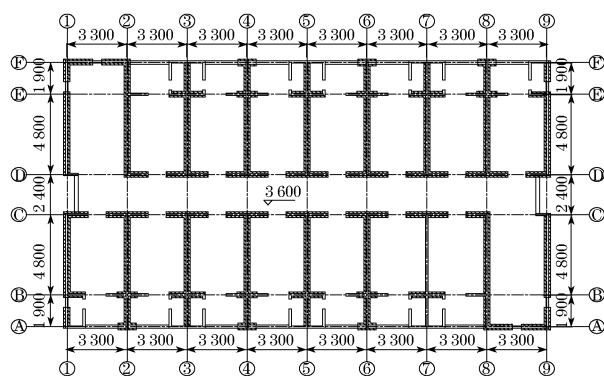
宿舍楼二层剪力墙平面布置图(单位:mm)
